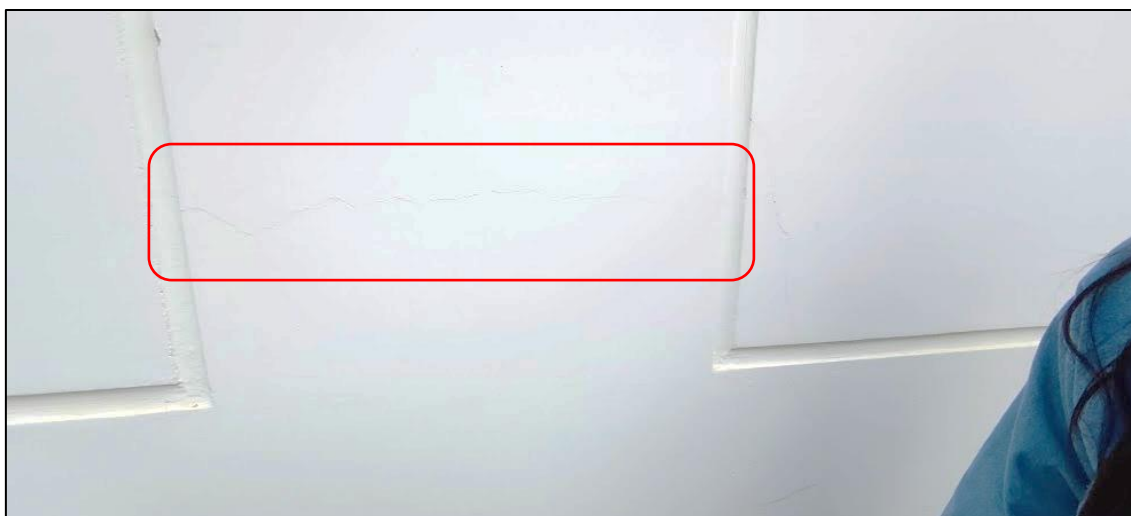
Vista de fisura horizontal en columna de fachada norte.
